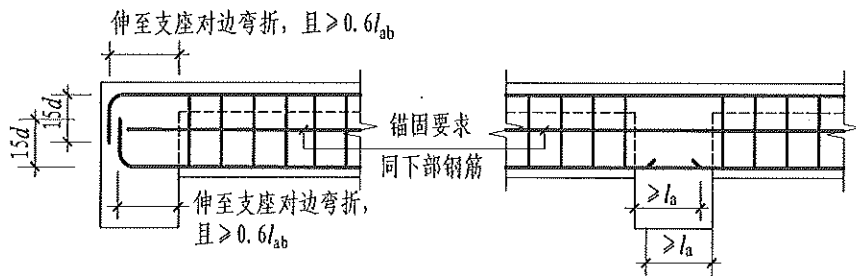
受扭梁纵向钢筋端支座构造 图4.13-3 受扭梁纵向钢筋中间支座构造
